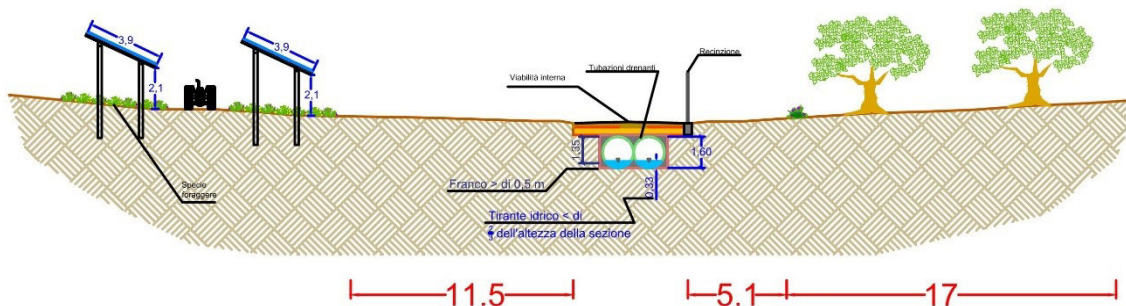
Attraversamento corso d'acqua localizzato all'interno dell' "Area A" con la viabilità interna di nuova realizzazione e indicazione posizione tubazioni drenanti a sezione circolare di nuova realizzazione – estratto dell'elaborato di progetto "Tav.34 Inquadramento su CTR ante e post operam su bacini idrografici"
